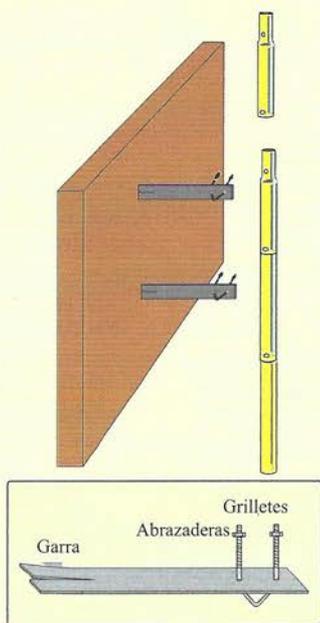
Ejemplo de instalación del mástil sobre un muro.
